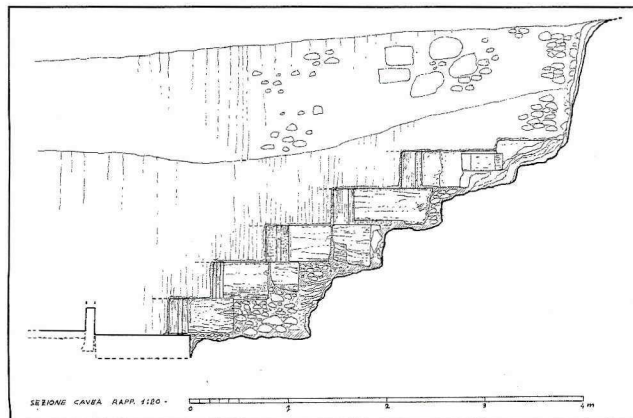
Terzo cuneo della ima cavea, sezione-prospetto (elaborazione di G. Troja).
